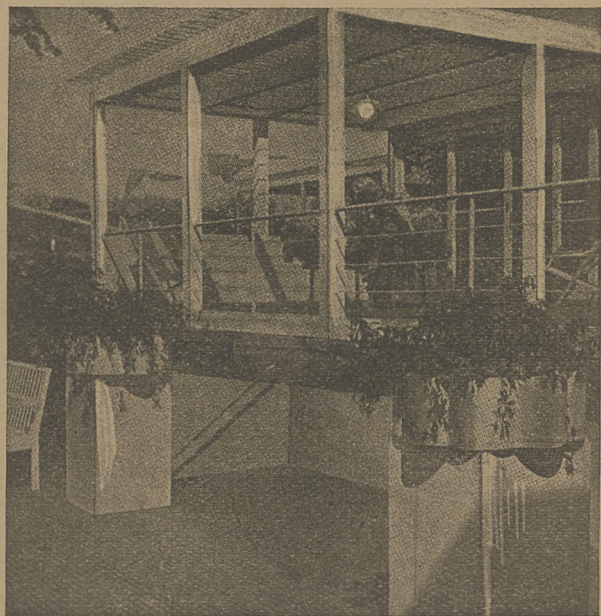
Widok betonowej pergoli przed obrośnięciem dzikiem winem. Z przodu widoczne betonowe wazony z kwiatami.
